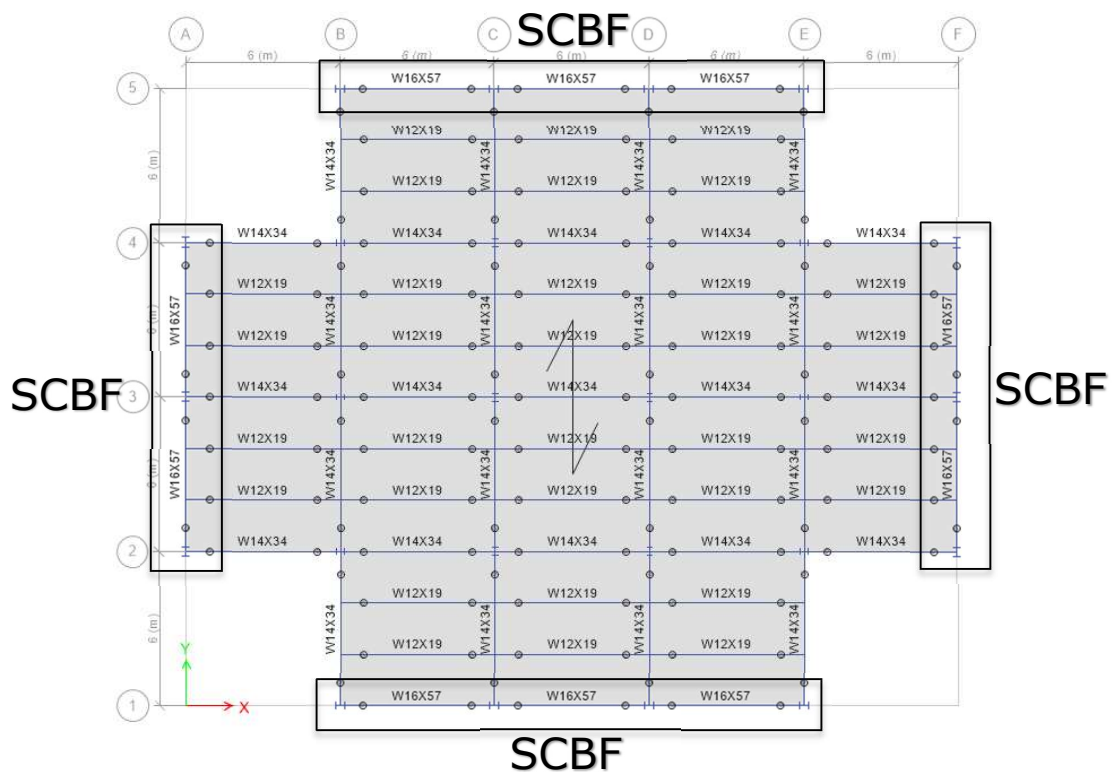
Vista en planta del modelo estructural en el software Etabs.
